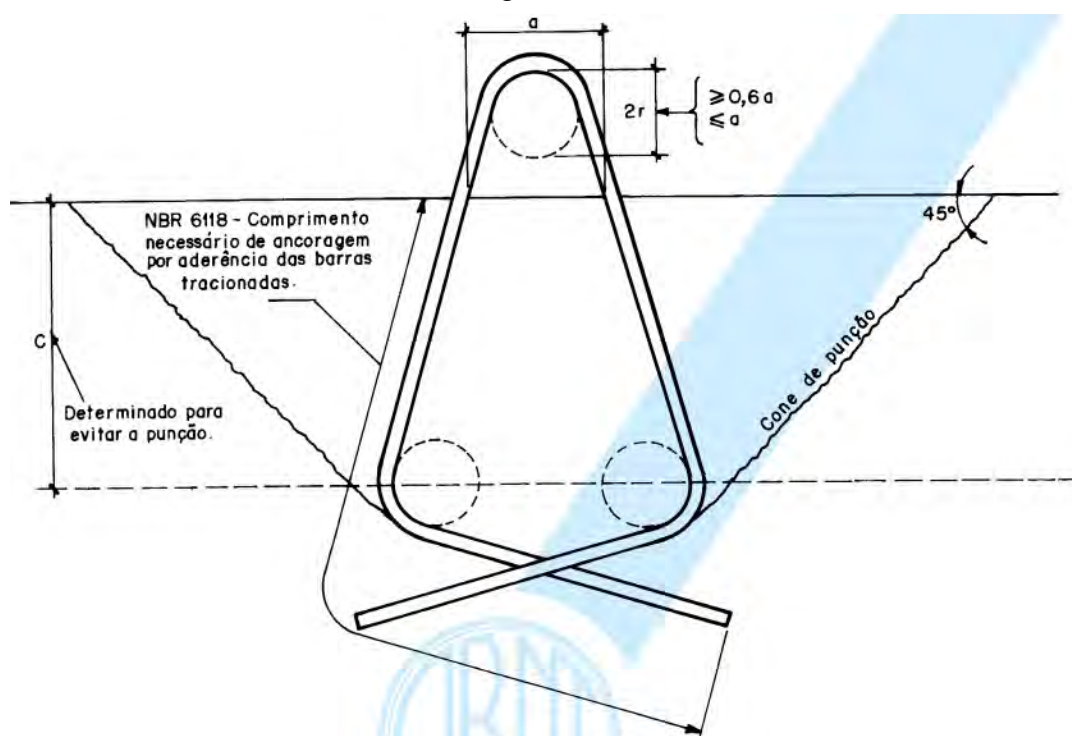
Esquema do dimensionamento de uma alça de elevação para pré-moldados
